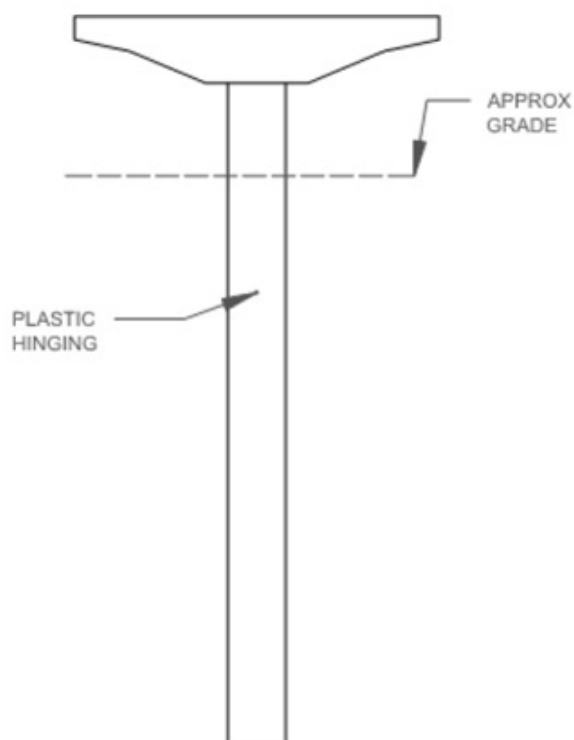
Elevación de la Monocolumna. *Fuente:* Memoria de cálculo de T.Y.Lin International.
